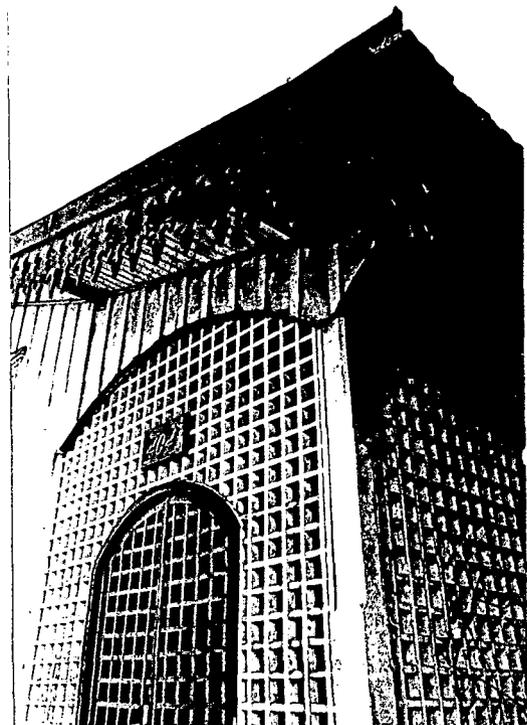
Casa Urti Machado, em Canoinhas. Detalhe do lambriquim, bastante semelhante à residência Olsen. Observe-se o vazado em madeira.
